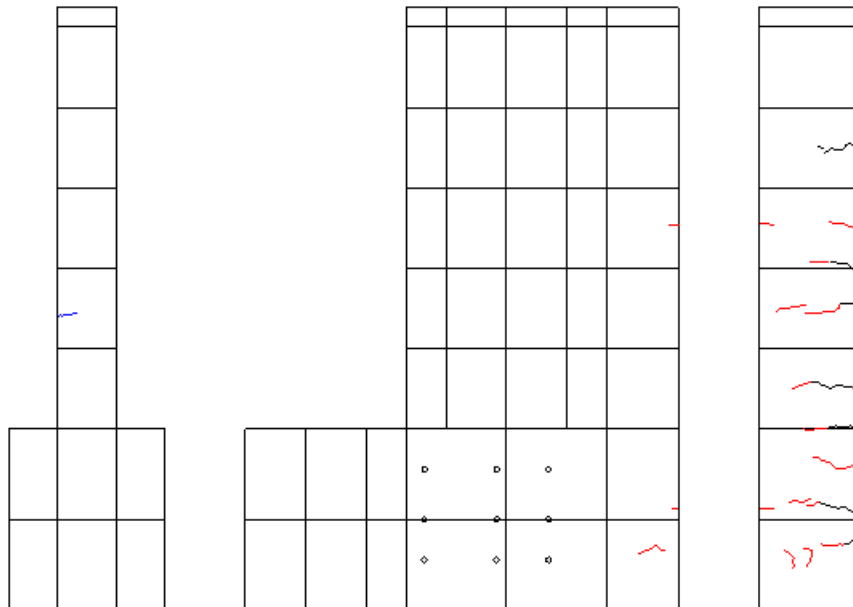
R=-1/1600 ひび割れ図
